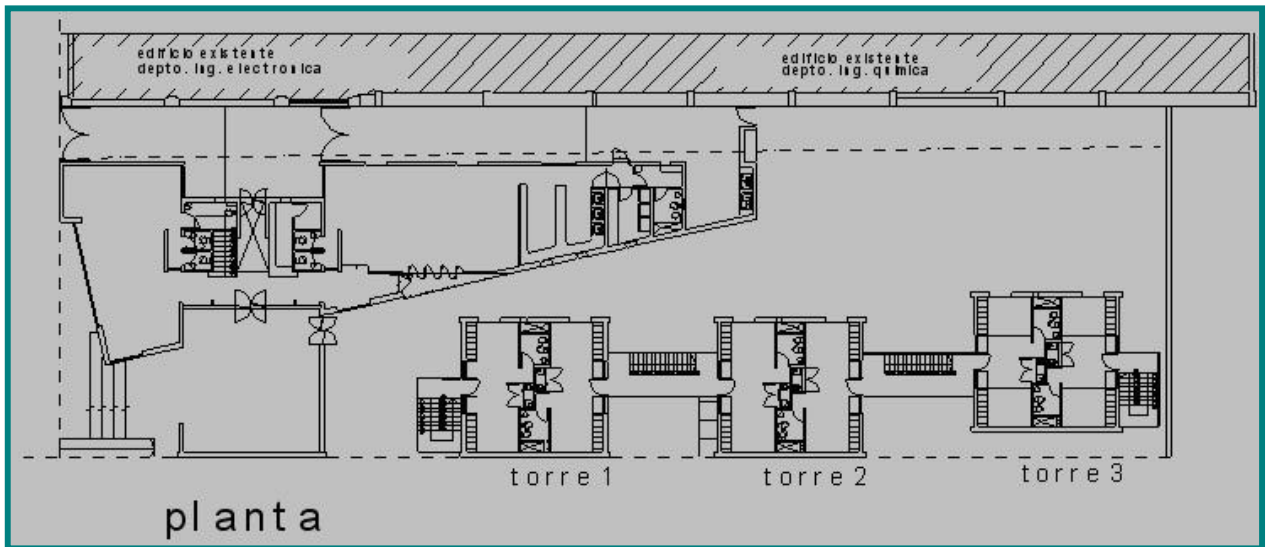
Planimetría general del complejo de la residencia universitaria a nivel de la Planta Baja
